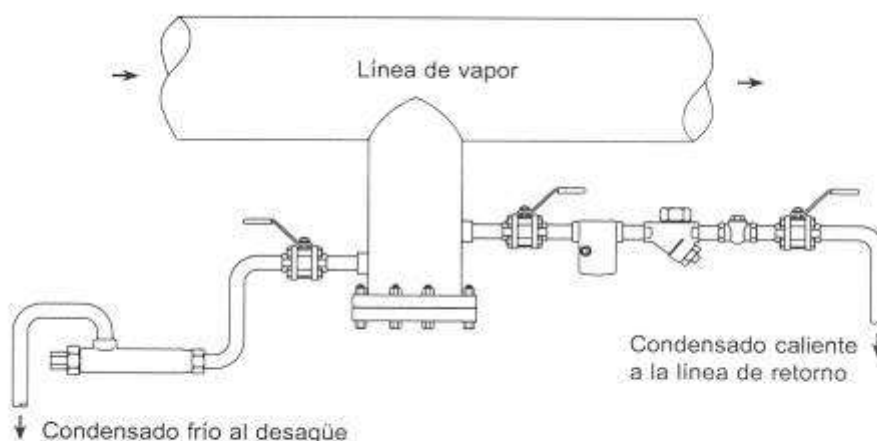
Drenaje de la línea principal con drenaje en paralelo para paradas
